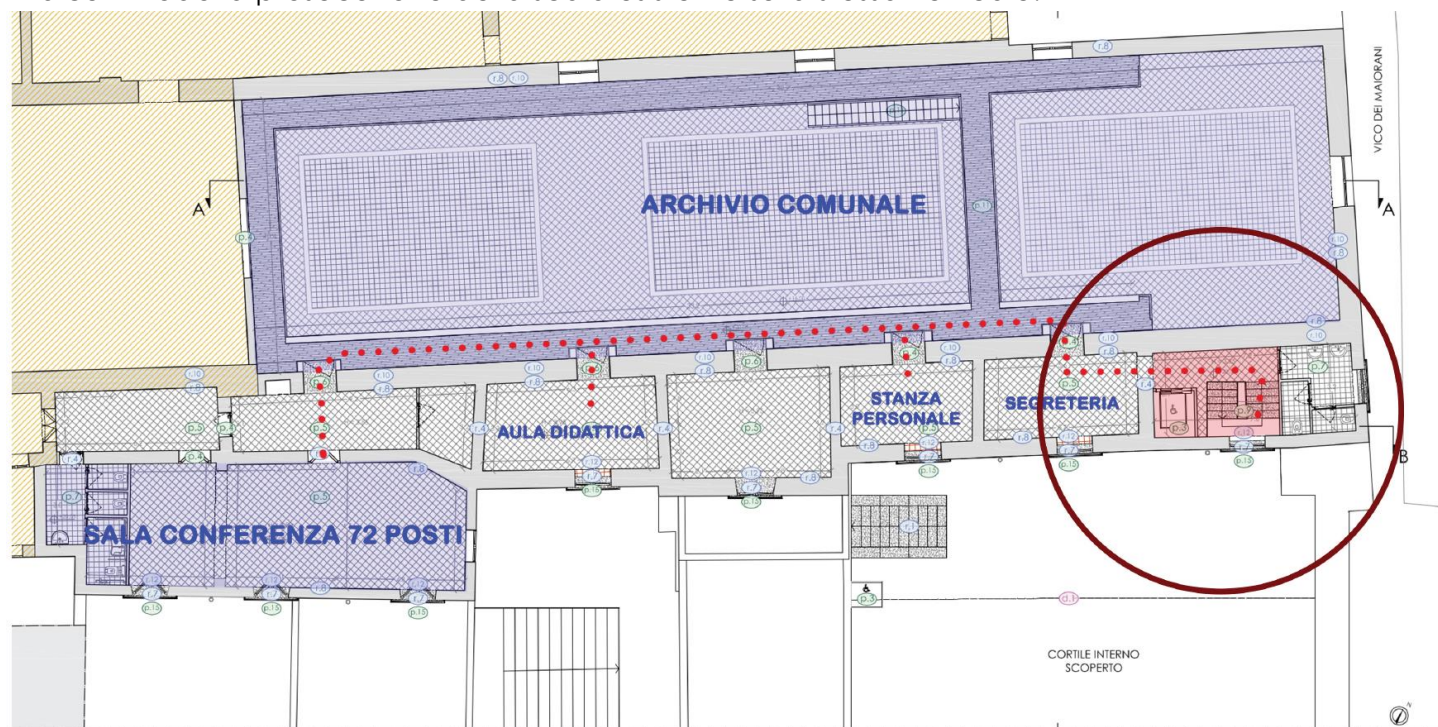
Progetto definitivo - pianta a q. 19.56 m
